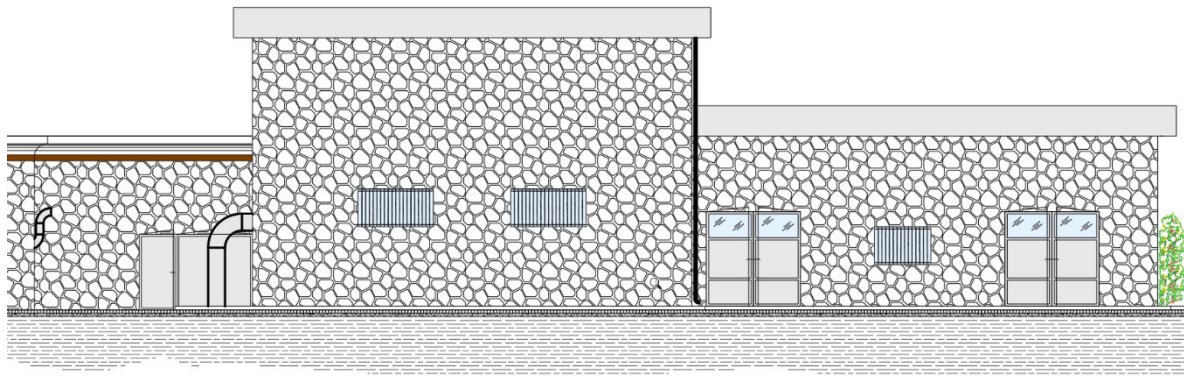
Prospetto ovest del nuovo impianto di Brancolino.
